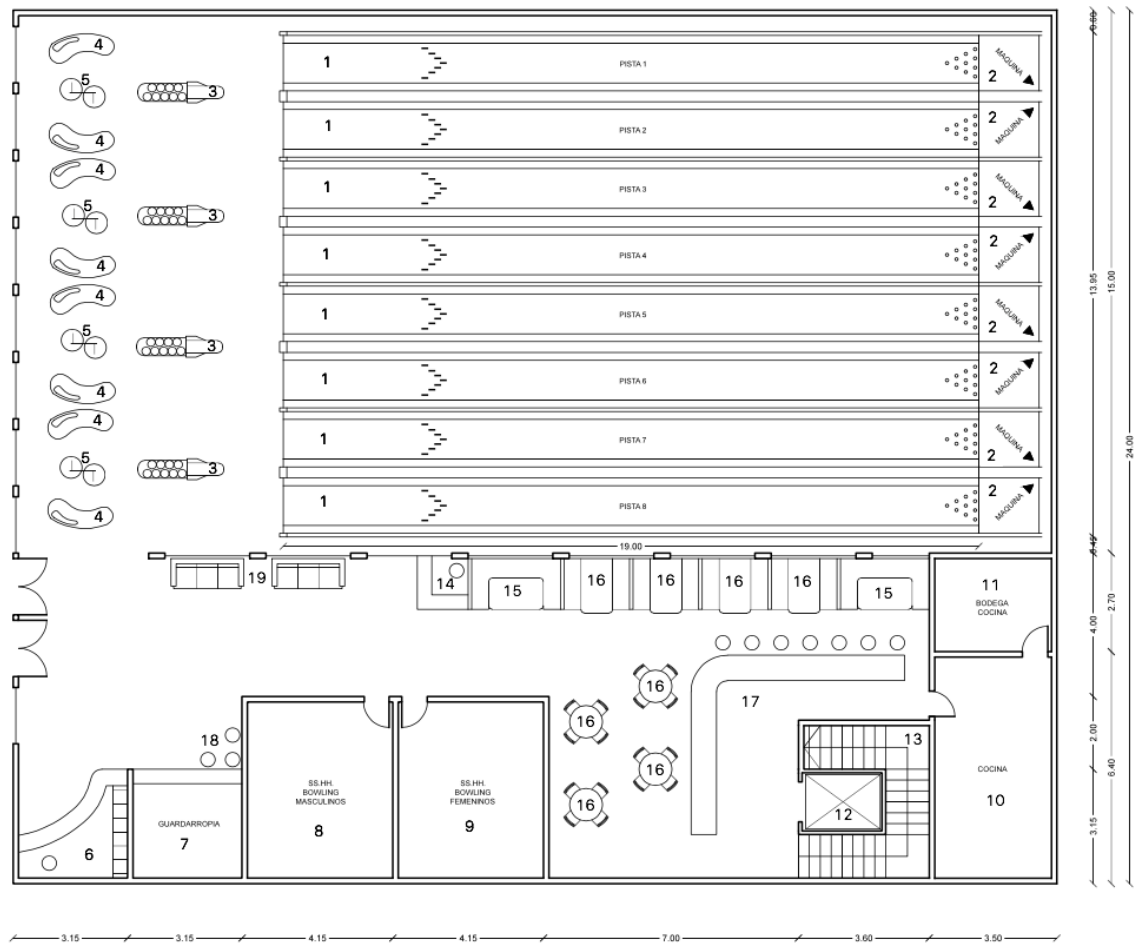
Layout Primer Piso independencias “Bowling Coffee”.
